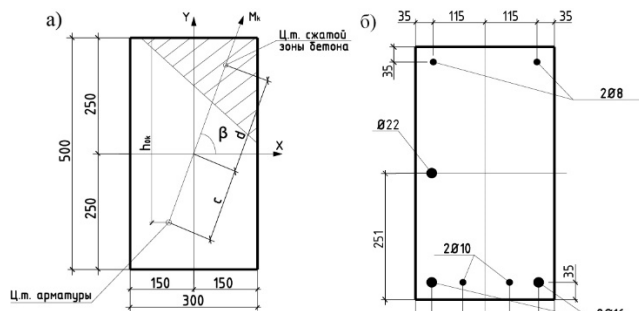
Базовый вариант балки сечением 500×300 (мм): а – расчетная схема; б – армирование
